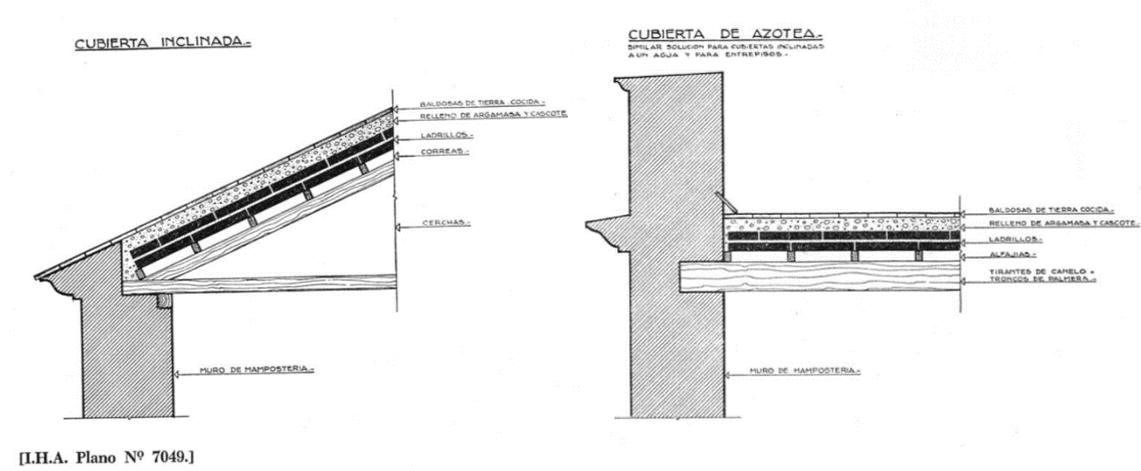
DETALLES CONSTRUCTIVOS. ARCHIVO IH
